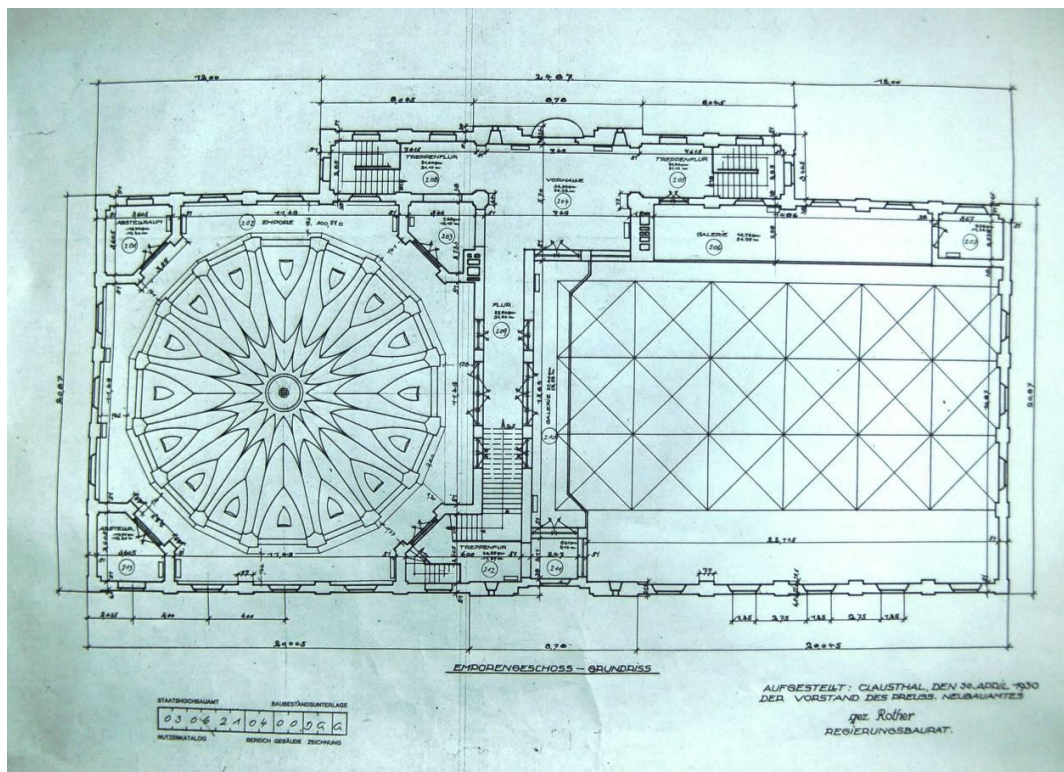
Aula und Turnhalle. Grundriss des Emporengeschosses.
